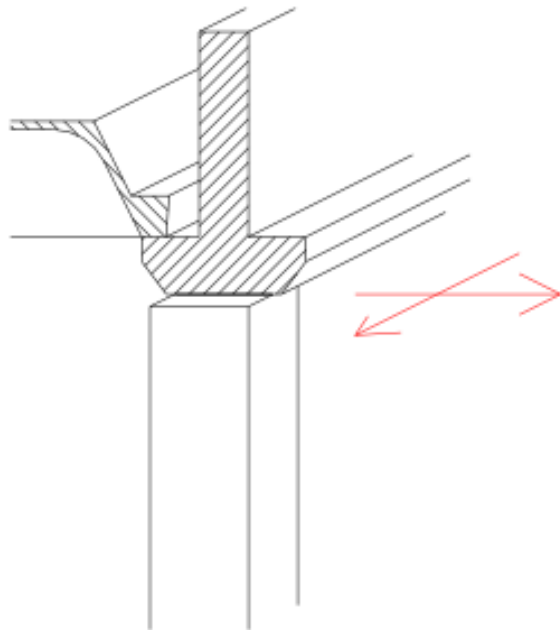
dispositivo di collegamento della trave TR al pilastro centrale
